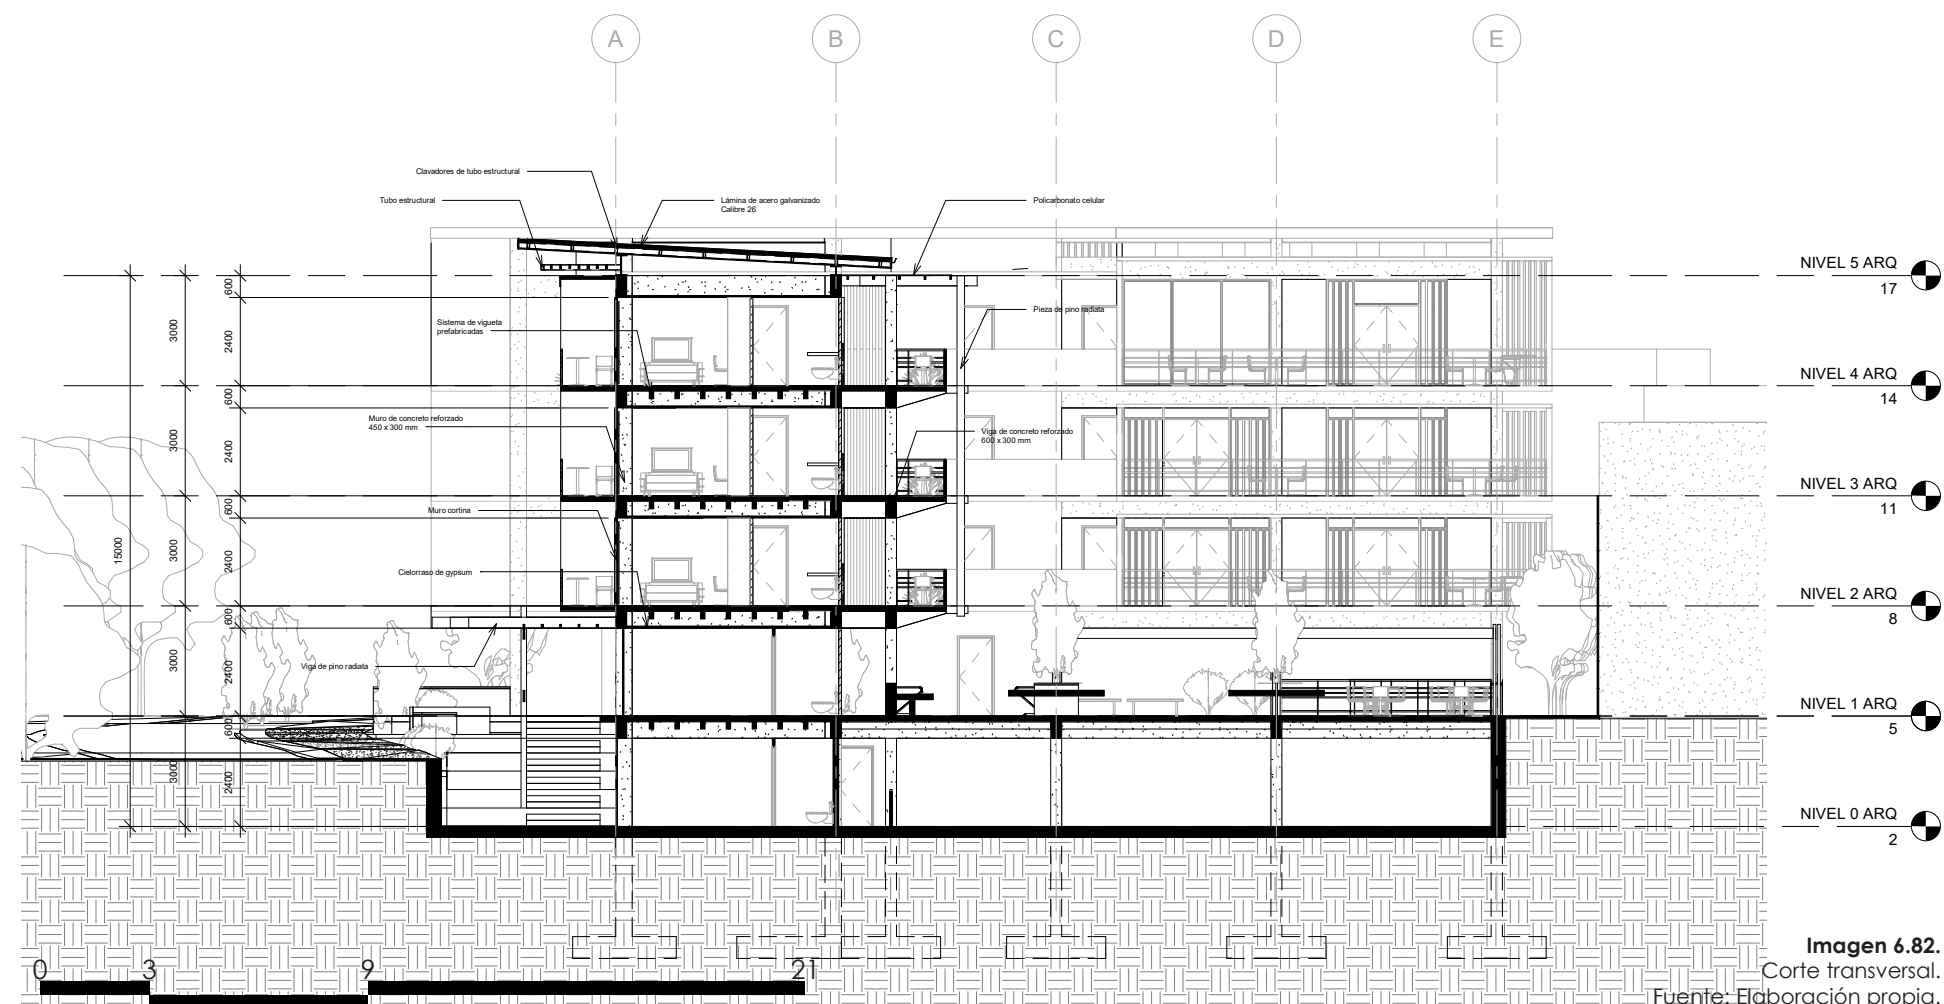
Corte transversal. Fuente: Elaboración propia.
